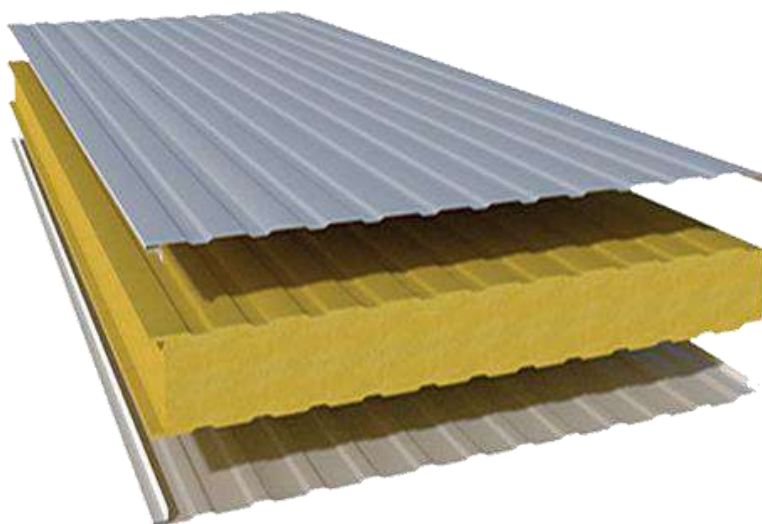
Panel Sandwich para cerramiento interior. Fuente: Container Home Insulation: The Ultimate Guide in 2020 (jjchouses.com)
